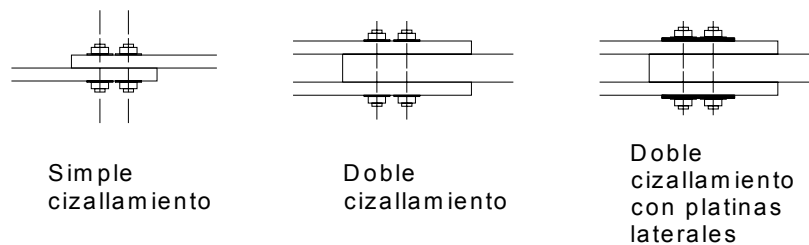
Uniones empernadas de dos o más elementos de madera
